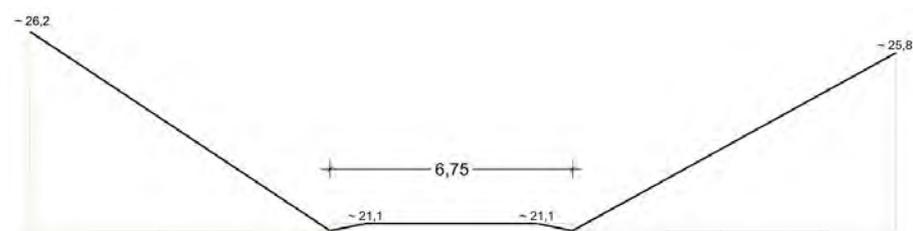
Querschnitt Q3 - Querprofil Bestand
